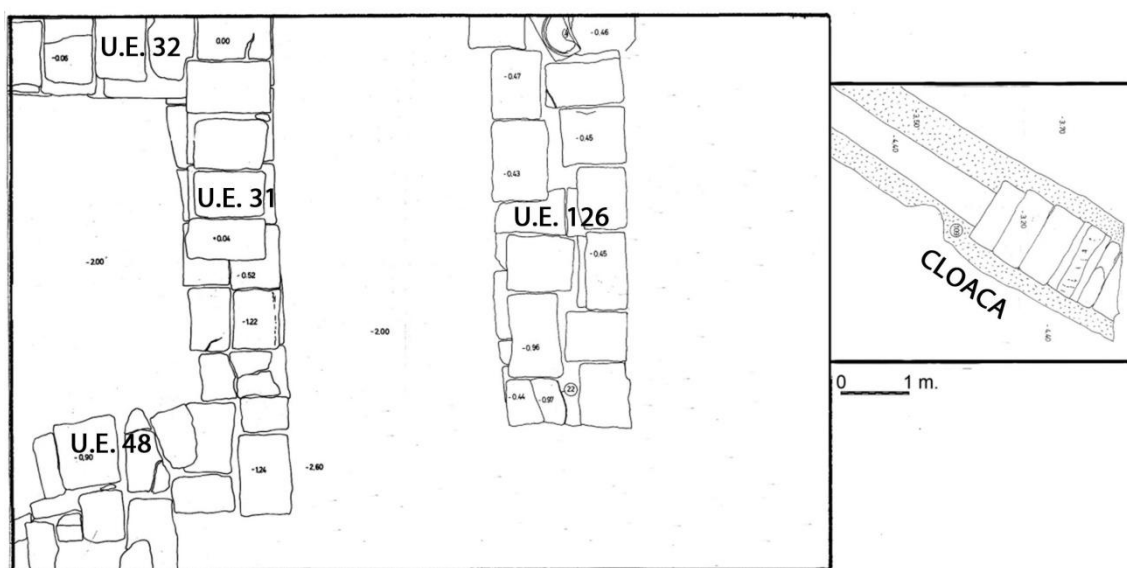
Av. Ronda de Isasa 6: planta de las estructuras adscritas al siglo VI. Modificado a partir de MARFIL, 2000b, plano s/n.
